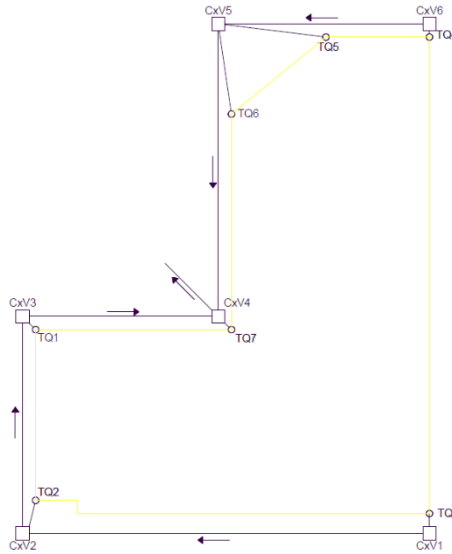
Traçado da rede de coletores e caixas pluviais
